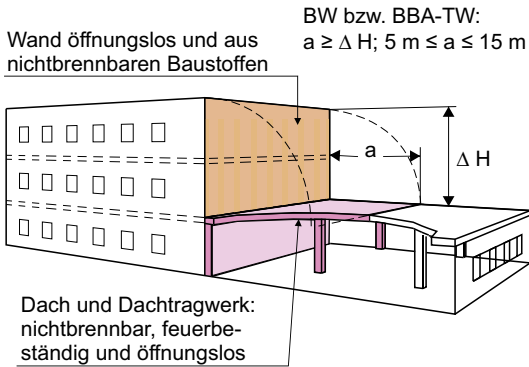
Beispiel für eine gleichwertige Alternative zur Überdachung der Brandwand bei Gebäuden mit unterschiedlichen Höhen.
